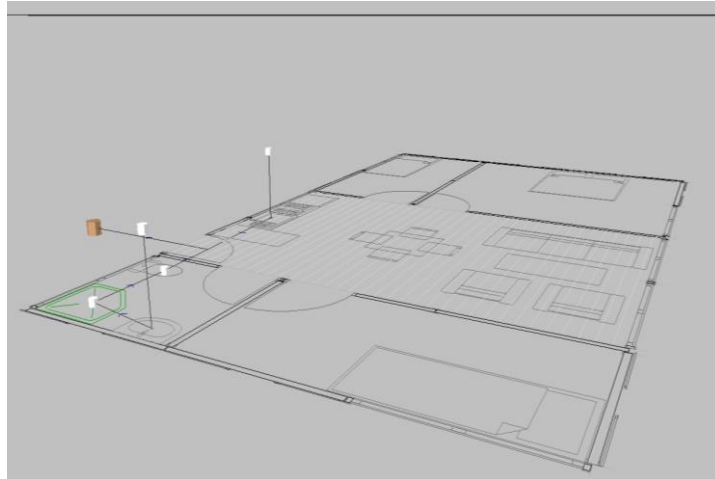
Conexión de saneamiento de la vivienda de 1 planta, vista 3D
